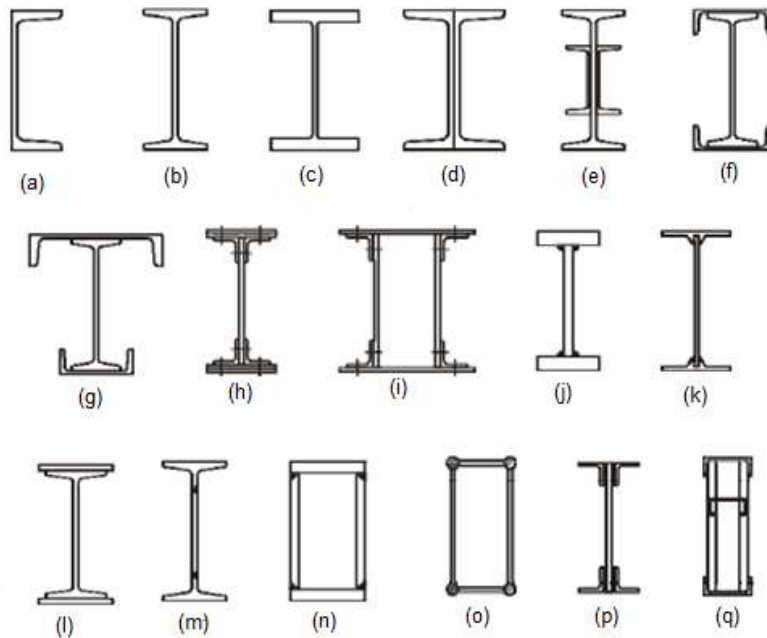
Vigas de alma llena (a, b, c, d, e, f, g,); Vigas de alma llena armadas (h, i, j, k, l, m, n) y Vigas especiales (o, p, q)
